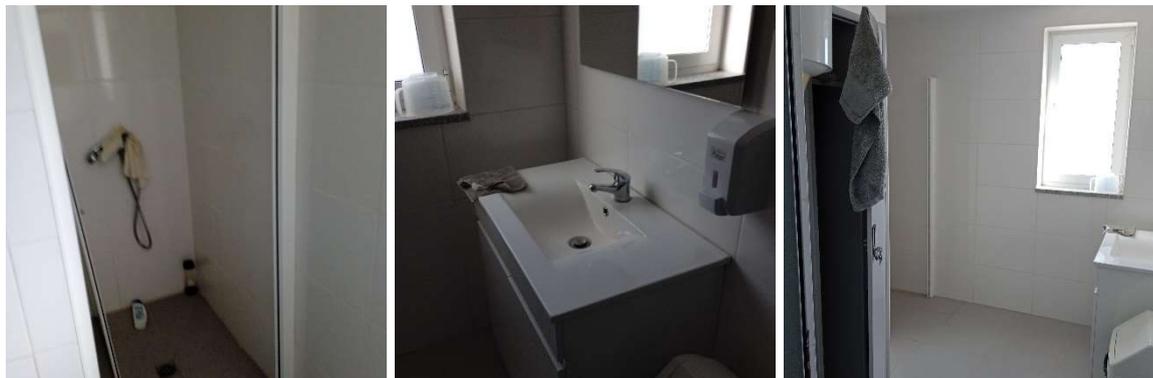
Instalações sanitárias do pavilhão 1 (existente)
